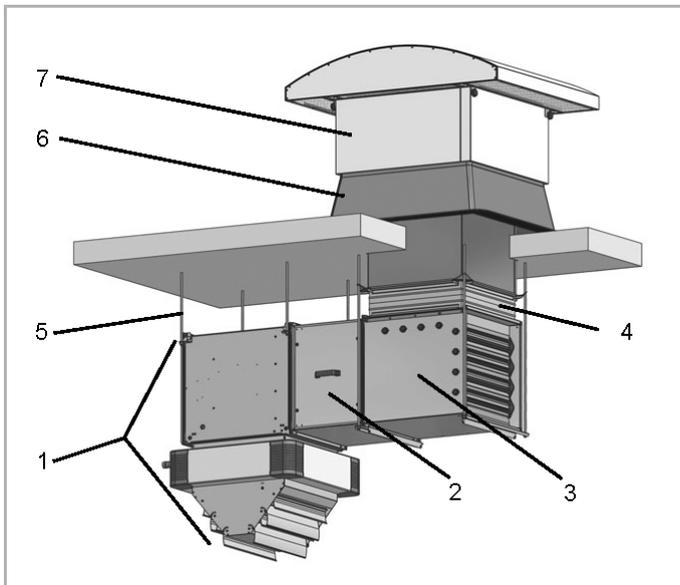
Deckenmontage mit Aufhängung „Decke“ (ZH#.5781)
